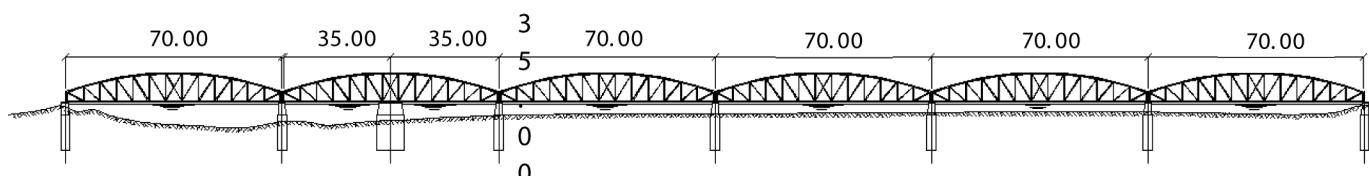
a : Elévation et coupe longitudinale du pont-rails de Zifta.
